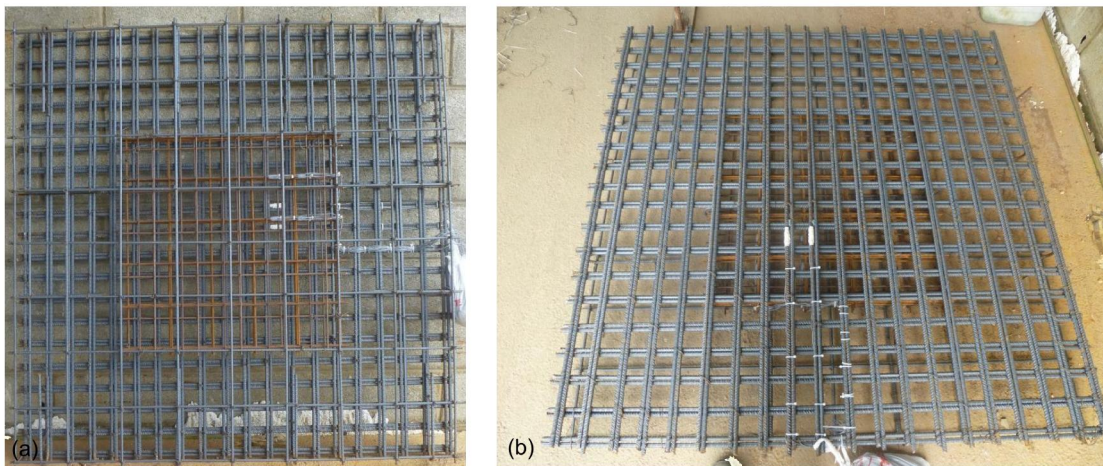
Fotografia do aspecto da armadura longitudinal da laje PBC5: (a) Inferior; (b) Superior.
